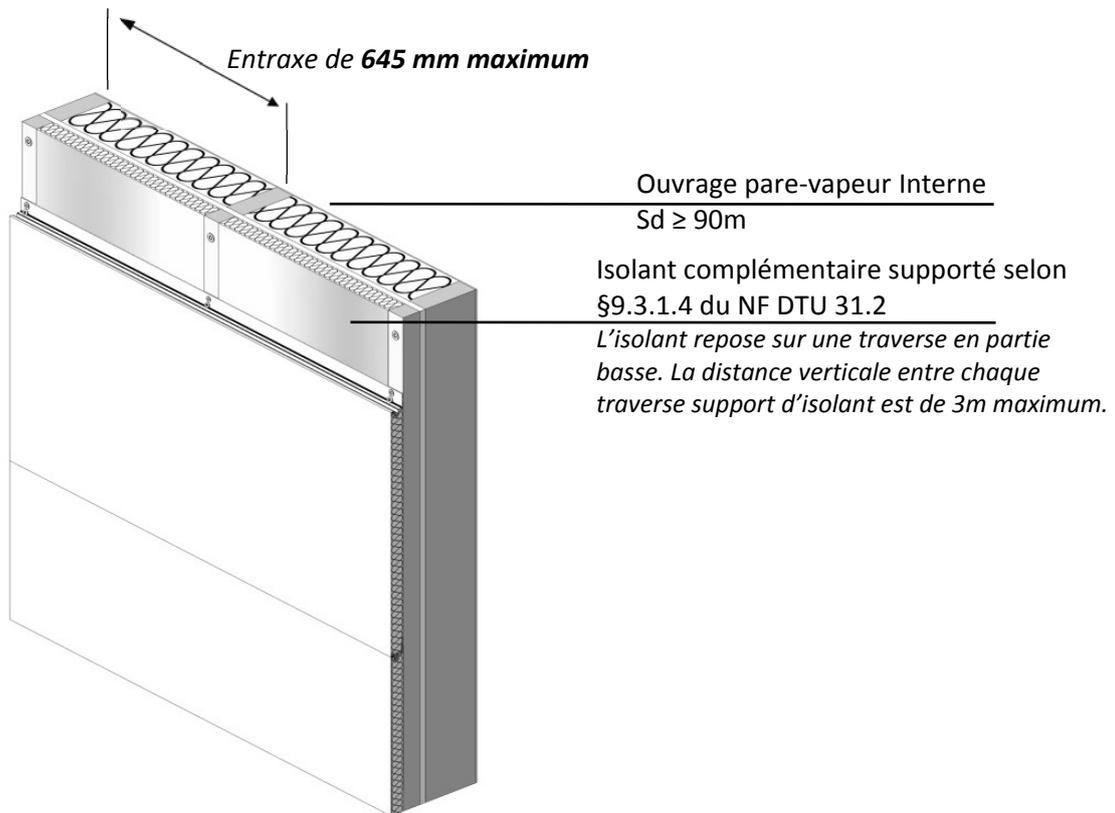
2 – Pose sur tasseaux avec isolant préalable (lames verticales) sur support COB
